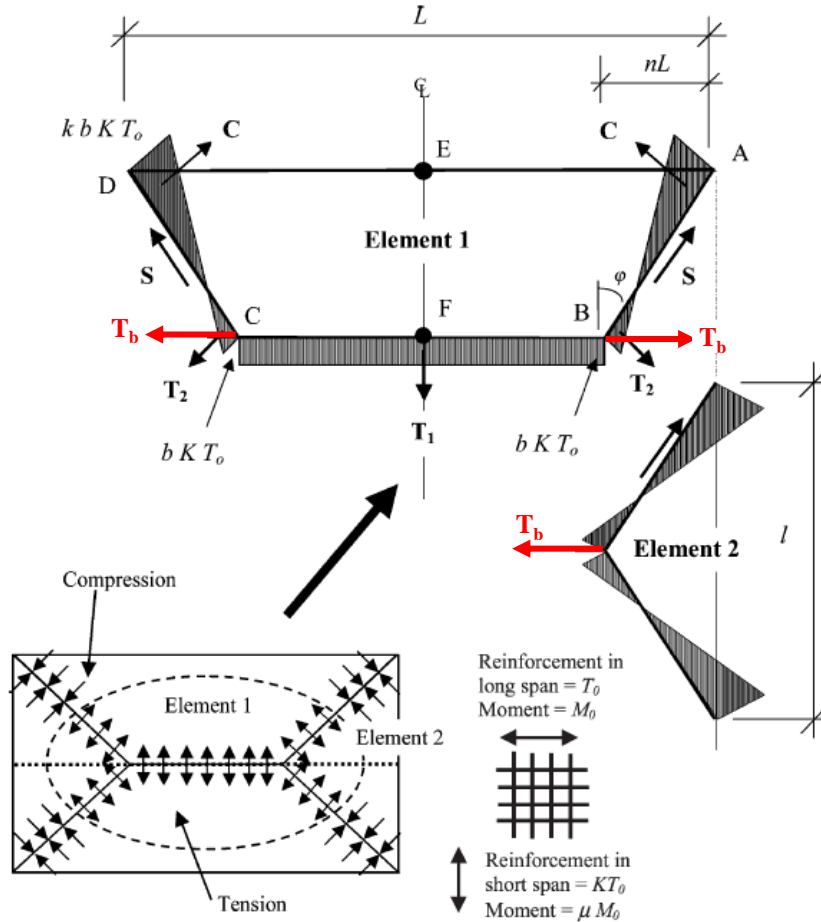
Efforts plans du système dalle - poutre [BAI 04a]
